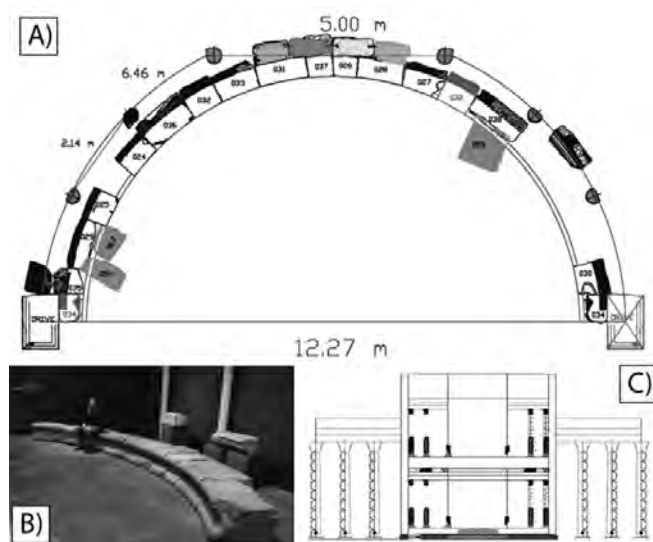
Schola de Corduba: A) Planta y elementos arquitectónicos identificados; B) Reconstrucción; C) Alzado hipotético a partir de los hallazgos (Torreras 2016).
